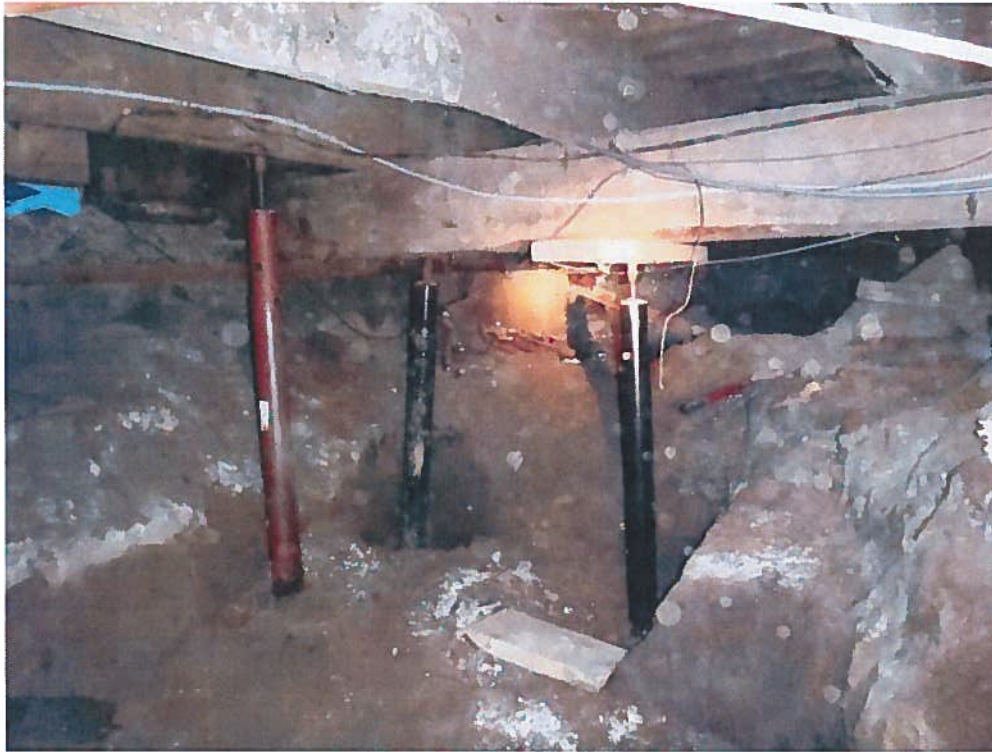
Vérins d'acier posés sous la poutre maîtresse vers son appui en façade avant et sous une solive
